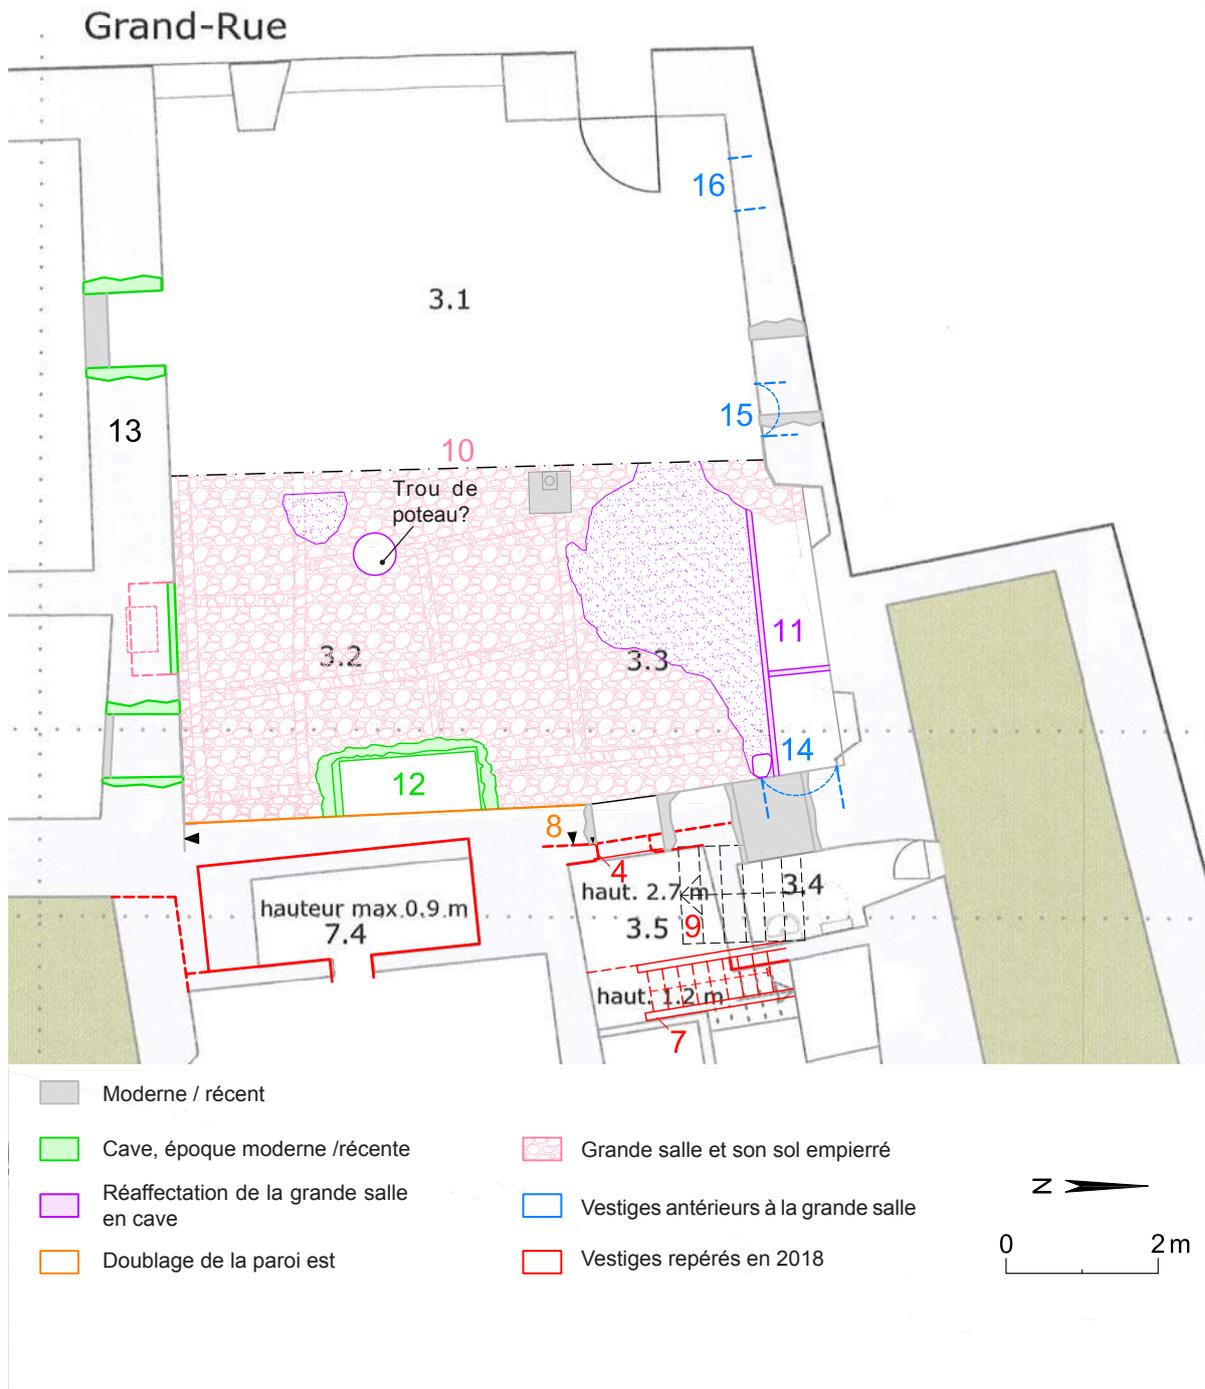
Plan des locaux L. 3.1 - 3.2 - 3.3 au rez-de-chaussée. Sur la base du plan de la Fondation Ateliers d'Artiste.
